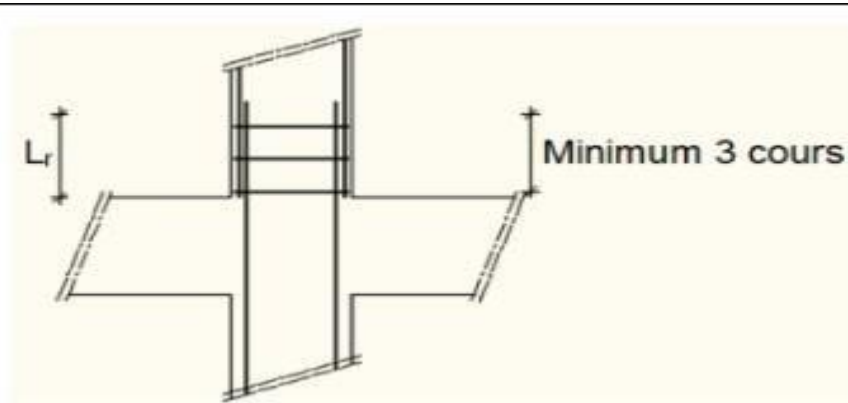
Armatures transversales dans la zone de recouvrement.
